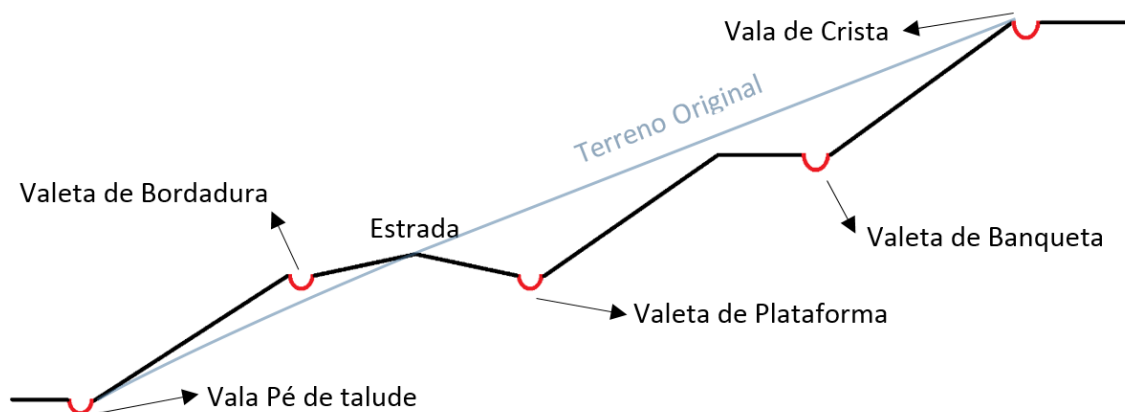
Esquema de um perfil misto (escavação e aterro) e das drenagens longitudinais numa via de comunicação terrestre.
